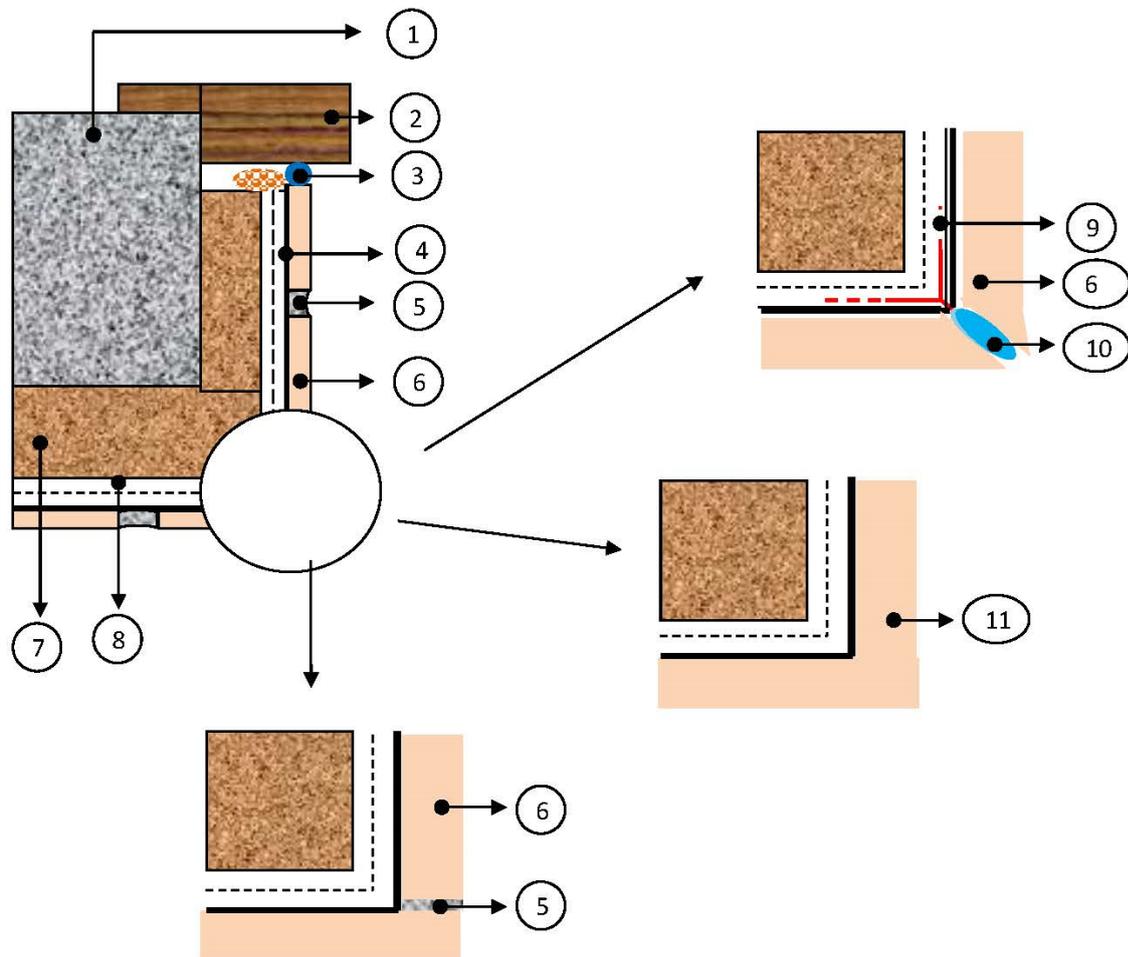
Plans de chevillage dans le cadre des finitions plaquettes de parement en terre cuite
